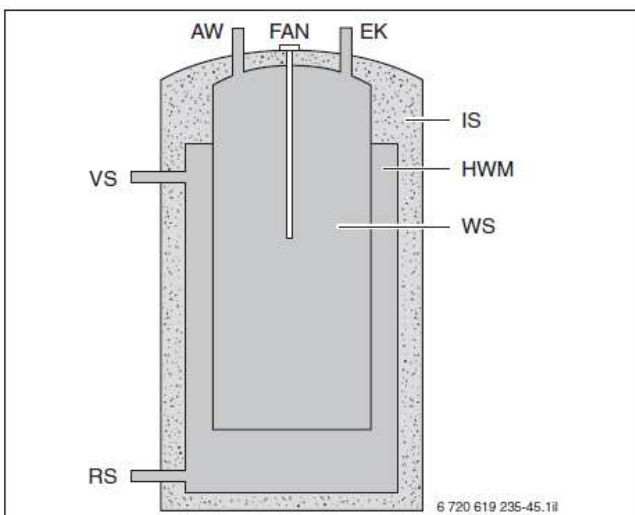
Конструкция бака-водонагревателя из высококачественной стали
